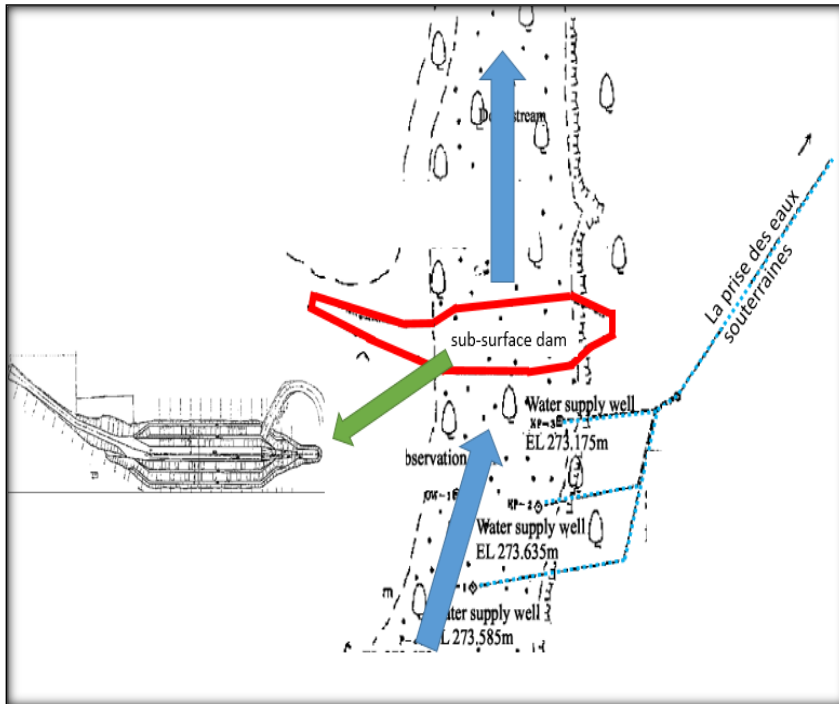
Vue sectionnelle du barrage de sous-surface de Nare
